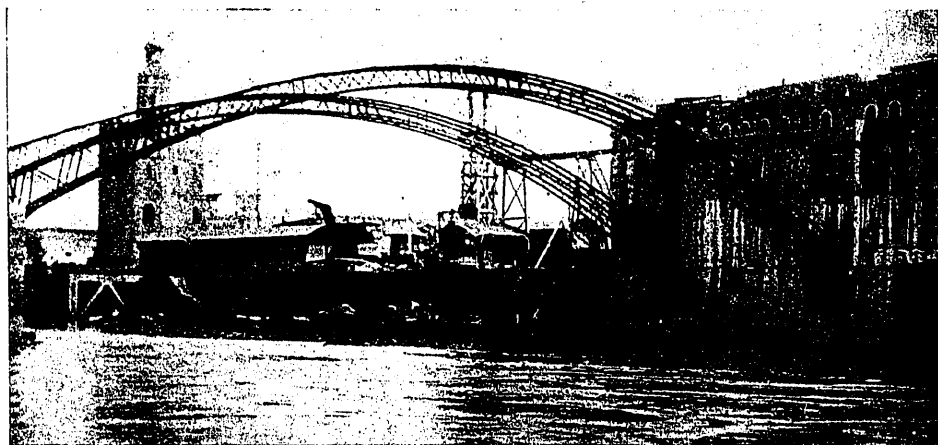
ª Puente de San Telmo en Sevilla. Conjunto de las armaduras rígidas.
